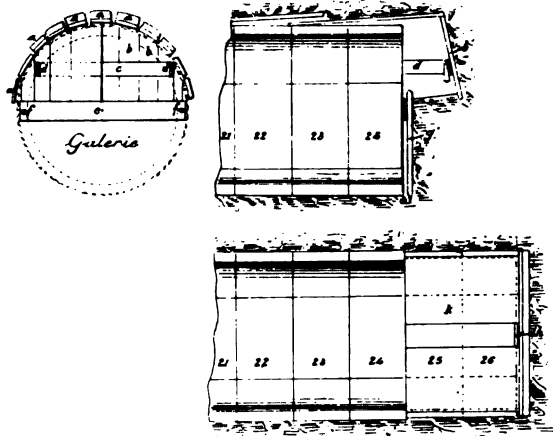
Coupes transversale, longitudinale et horizontale pour la pose des anneaux.
